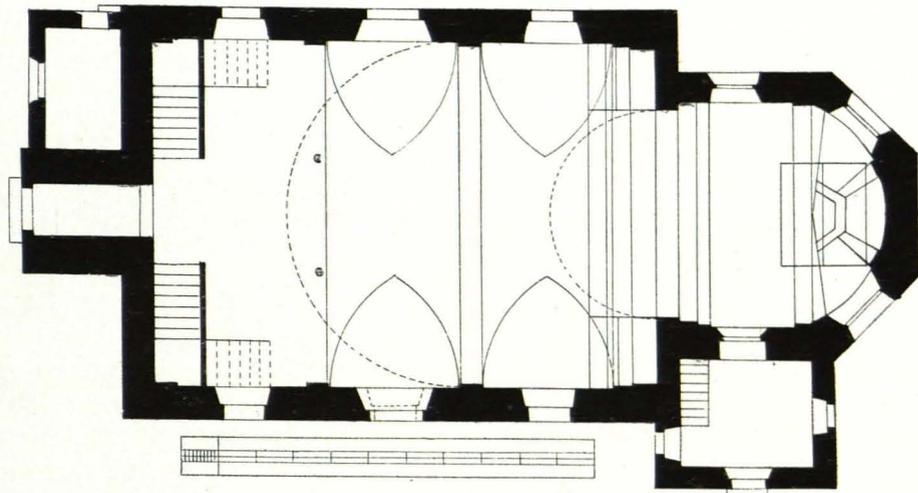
Elixhausen, Pfarrkirche, Grundriß 1:200 (S. 41)
